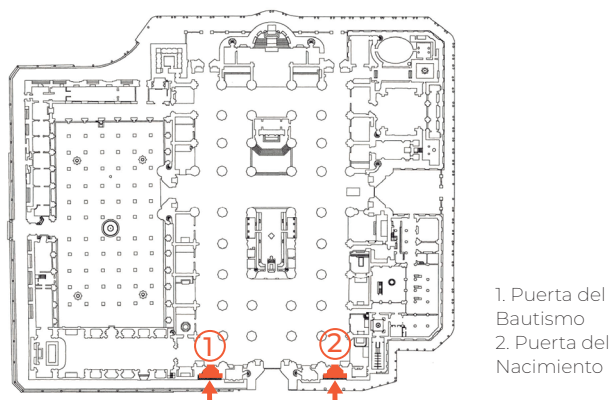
Planta de la Catedral de Sevilla con localización de portadas de Nacimiento y Bautismo. Fuente: Año: s.f.
